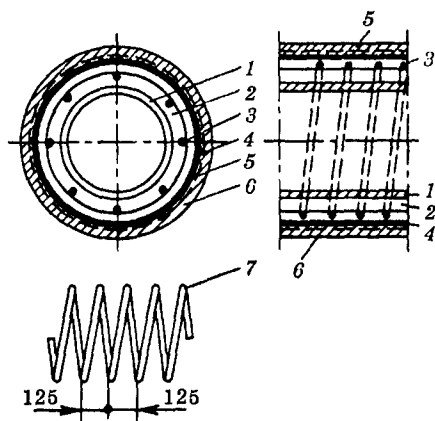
Конструкция монолитной армопенобетонной изоляционной оболочки
